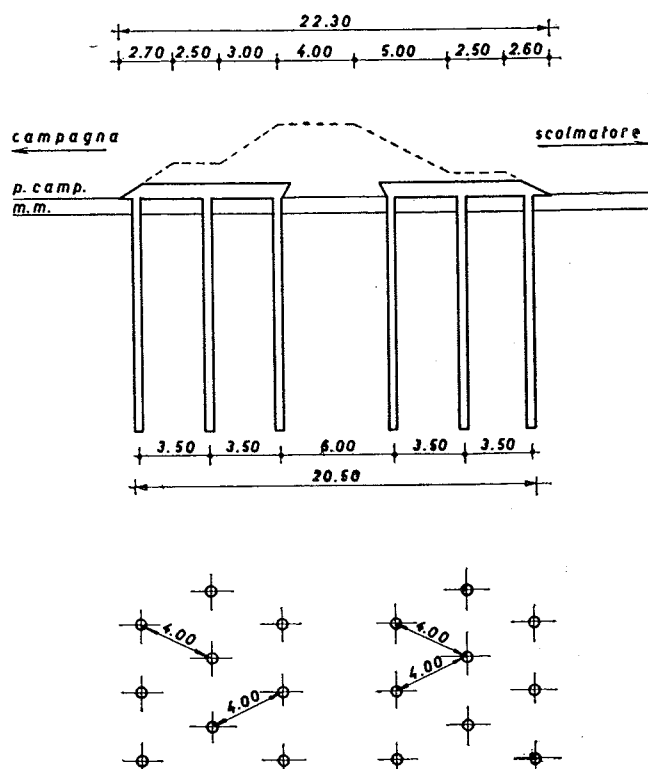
Sezione trasversale e pianta del drenaggio con pali di sabbia
